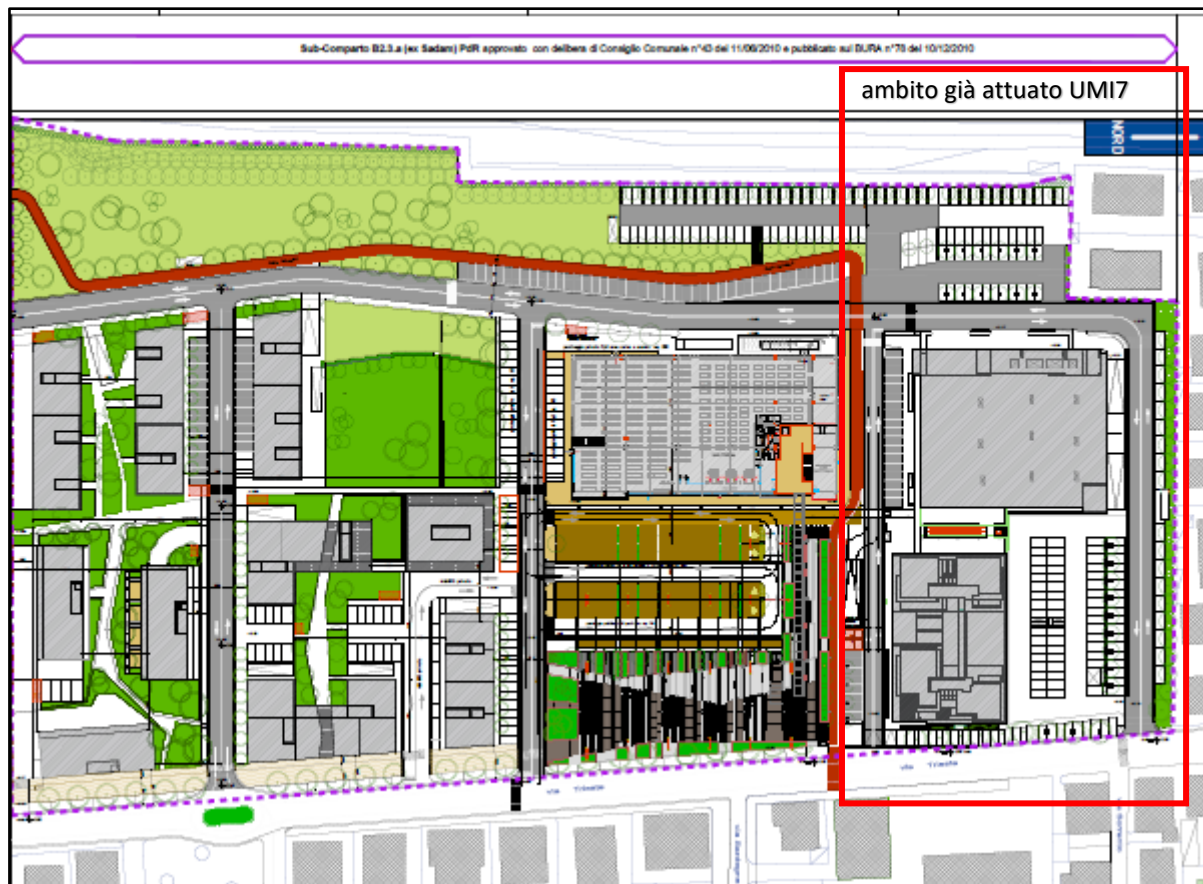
Planimetria proposta di Variante del PdR ex-Sadam con individuazione parte già attuata (UMI7)
